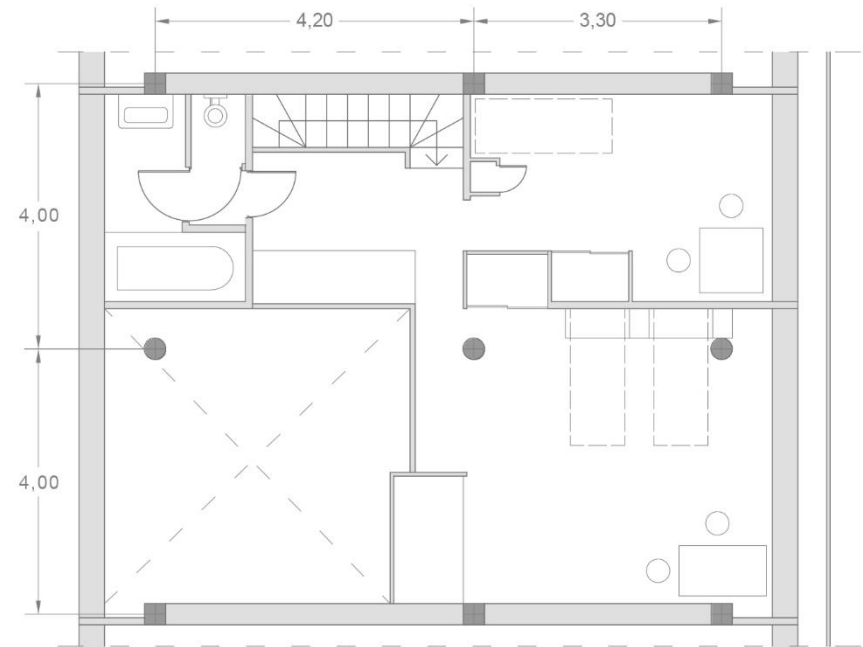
Planta primera de tipología K. Fuente: Elaboración propia
